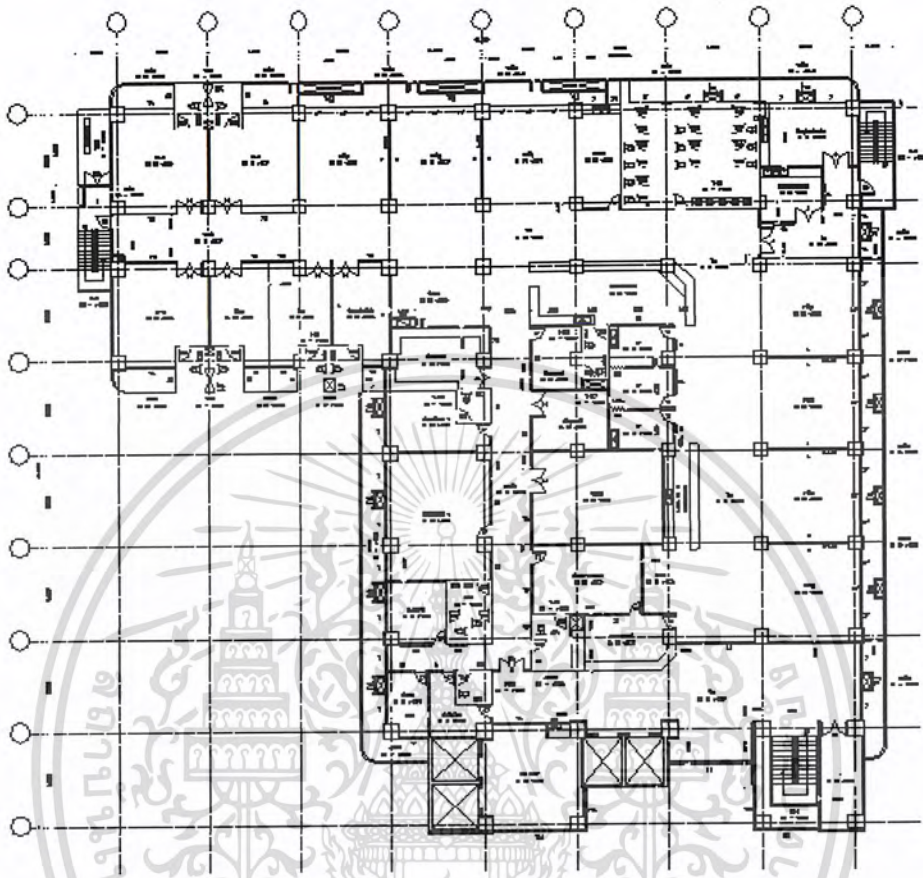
แสดงพื้นที่ชั้น 3 rd FLOOR PLAN
